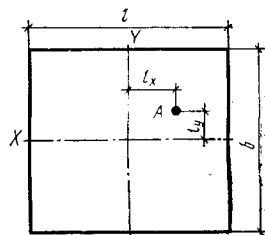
Схема внецентренной загрузки фундамента относительно двух главных осей
